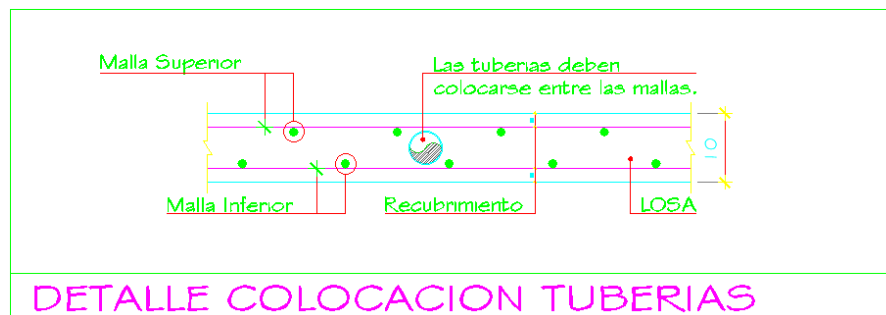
Detalle instalación tubería en Losa de entepiso
